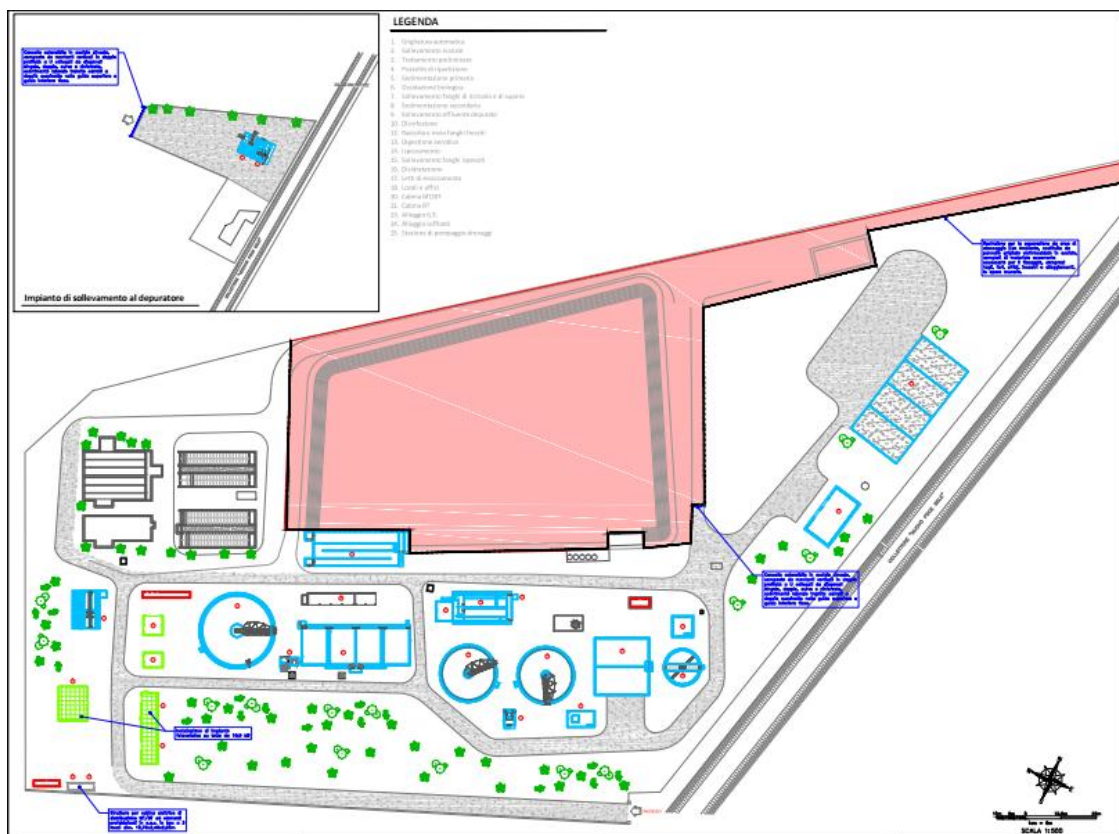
stralcio planimetrico dell'impianto di progetto
